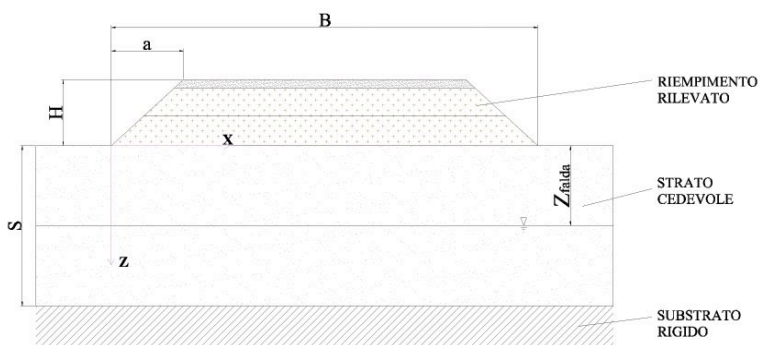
schema di un rilevato leggero senza scavo parziale del terreno di fondazione.
